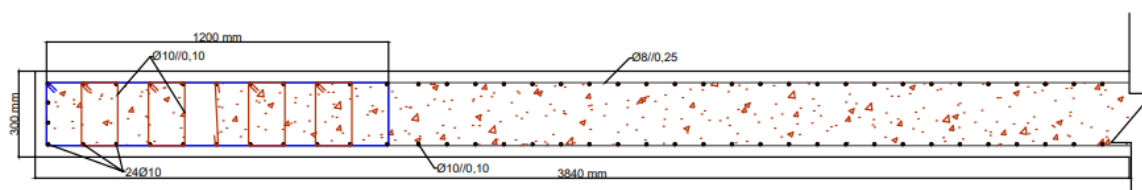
Pormenor construtivo da secção transversal da PA.1
